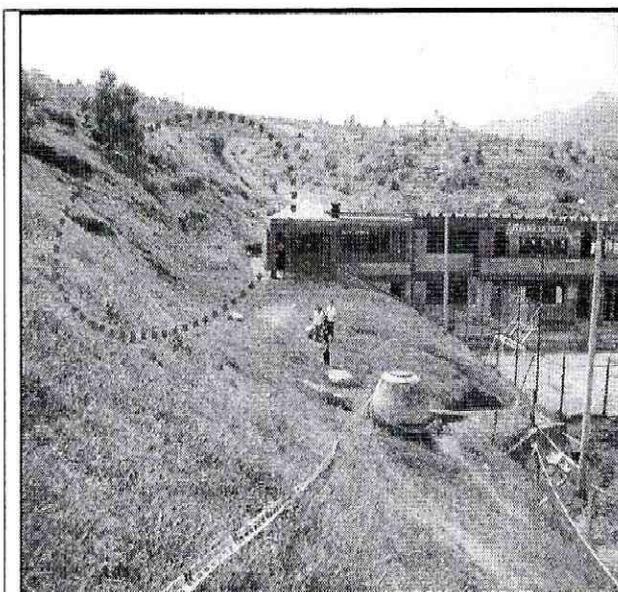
Vista terraza 1 vía al Llano sector de las Carrera 5 entre Calles 72D Bis y 73 Sur donde no se evidencian obras para el manejo del drenaje superficial
